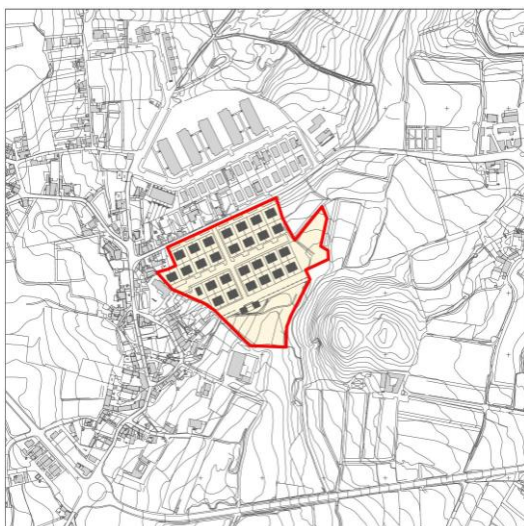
Planta do Alvará de Loteamento n.º 21/06
